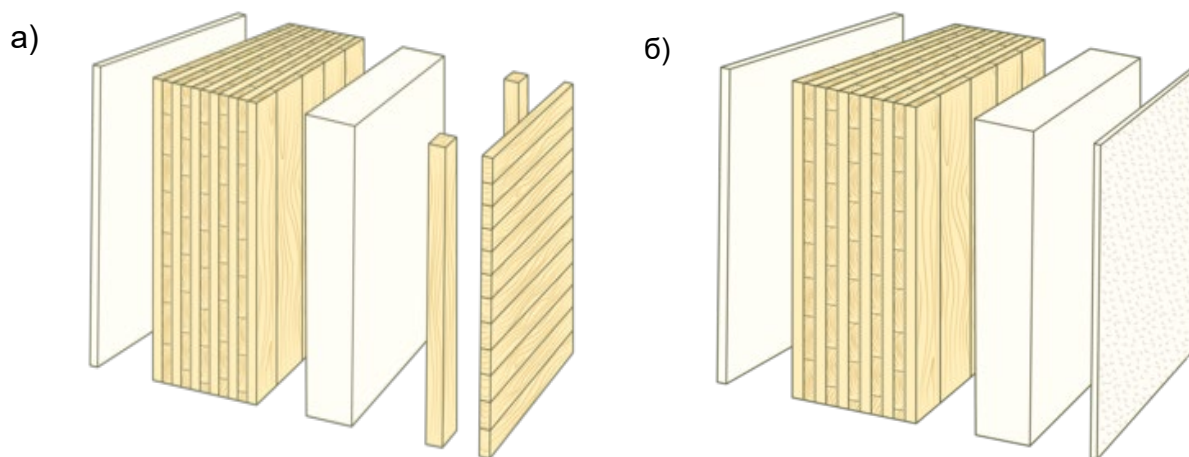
Примеры отделки наружных панелей: а) вентилируемый фасад, б) штукатурный фасад.
